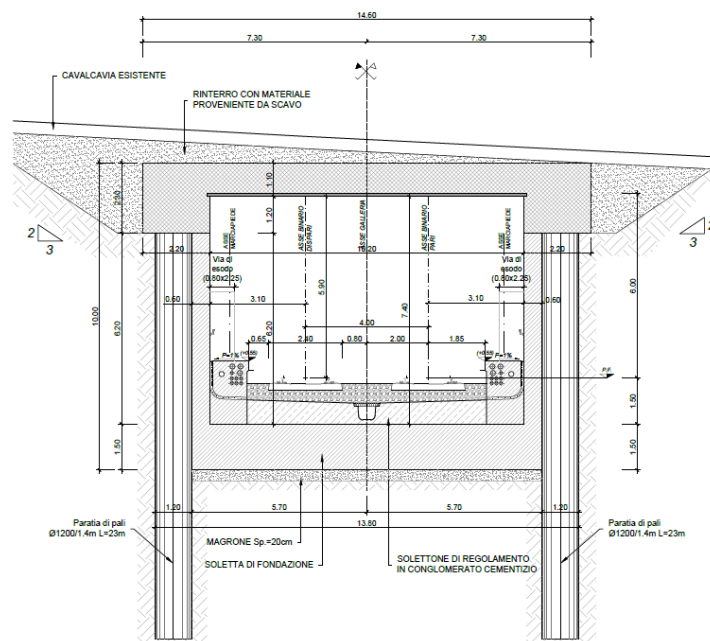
Sezione tipo GA – Sezione tipo 3 (GA52)
